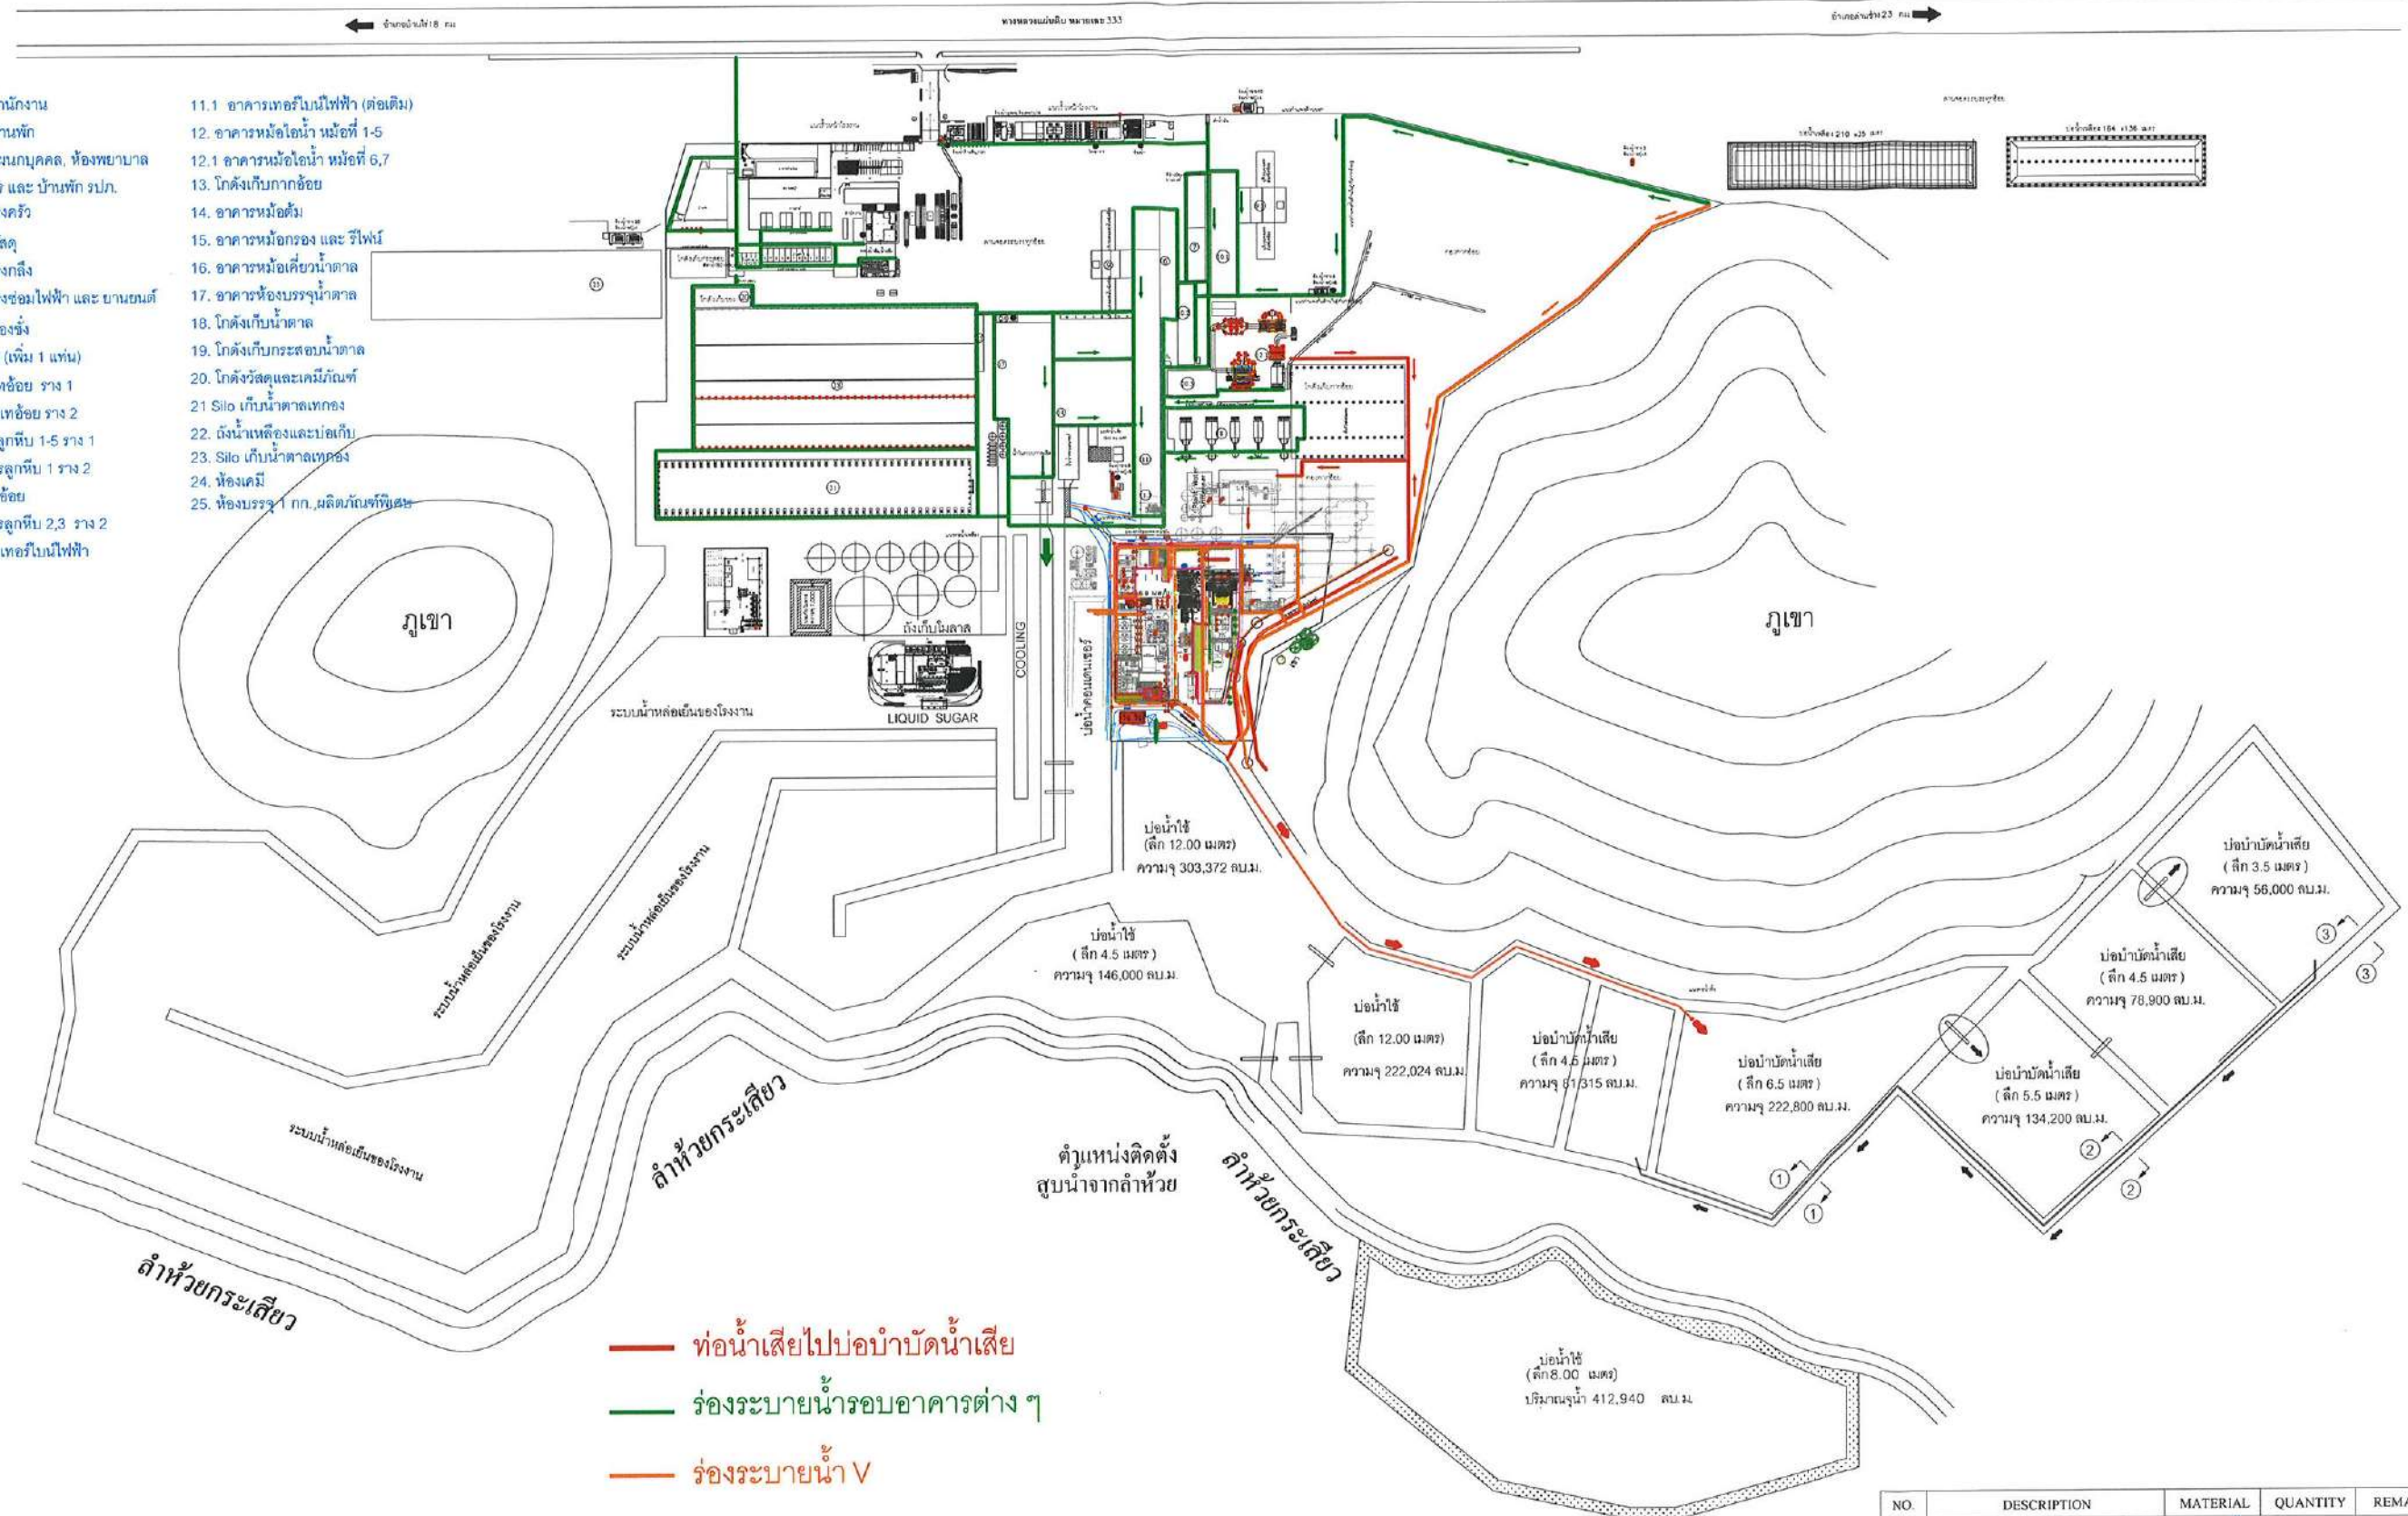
ระบบระบายน้ำของโครงการ
